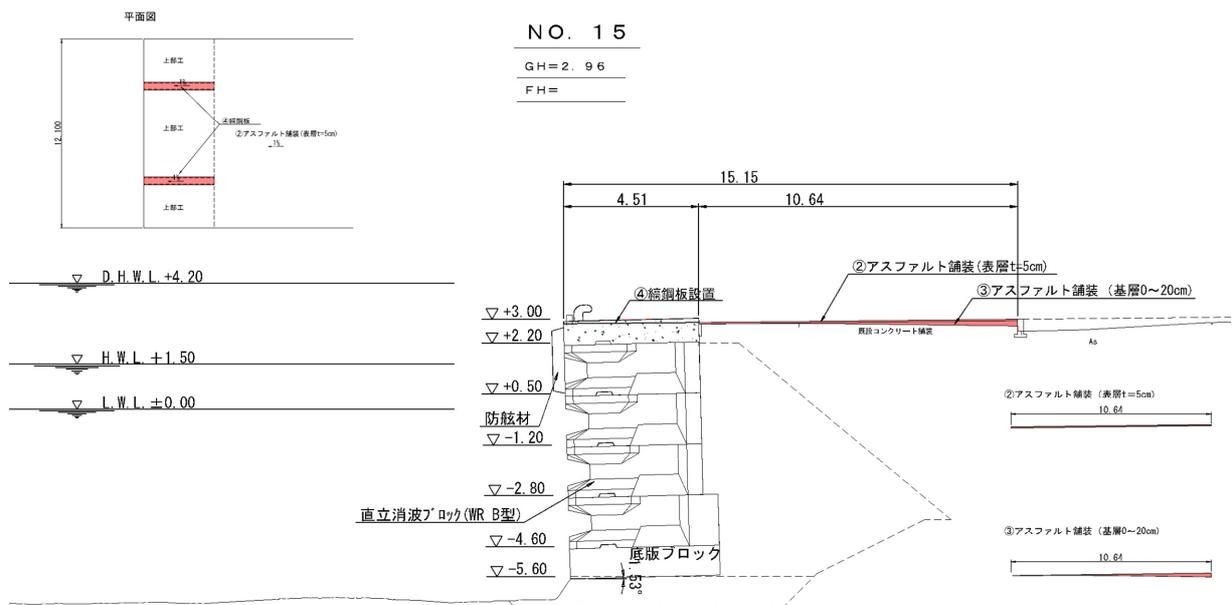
No.18 常陸那珂港区_北ふ頭地区岸壁 (-5.5m) I,J,K の断面図(復旧後)
